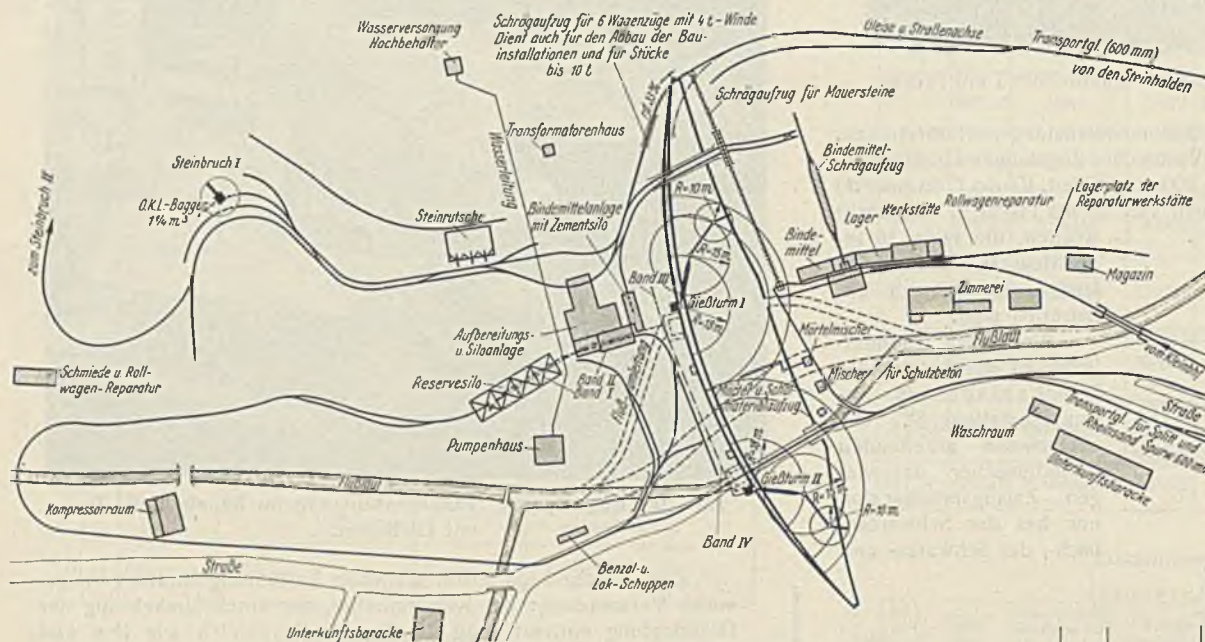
Aggersperre. Baustelleneinrichtung. Lageplan.
